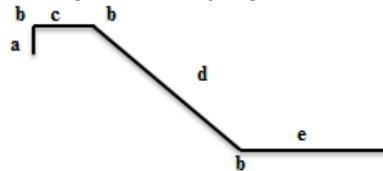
18 Detail Tulangan Plat Bordes 1 Arah y
